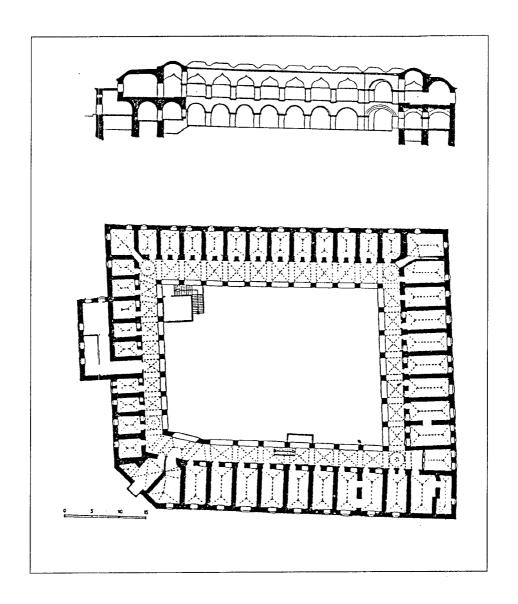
مسقط افقي لبادستان سليمان باشا أسفل مسجده في ترافنيك (Pašić: عن)
